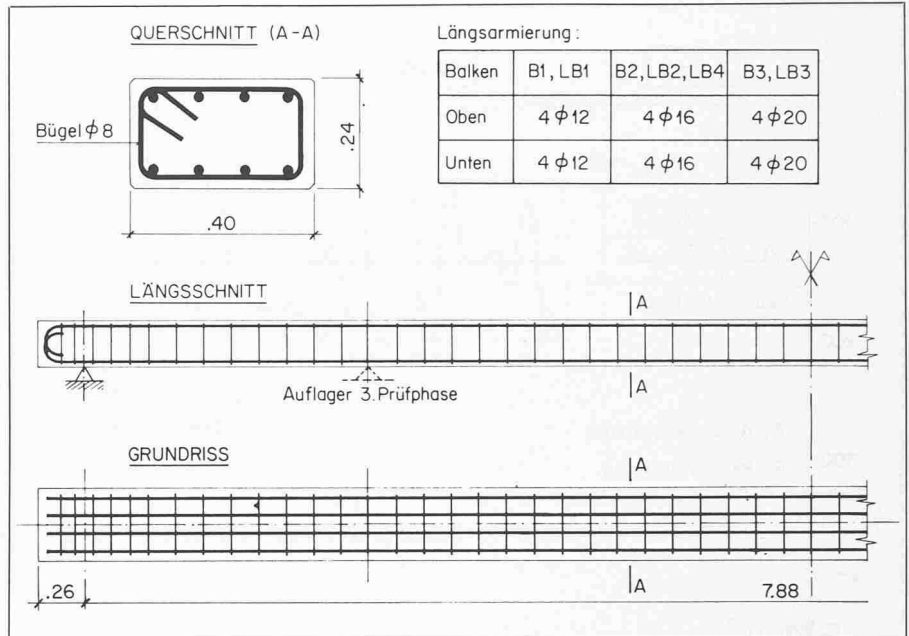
Abmessungen und Armierungen der Leichtbeton- und Betonbalken
